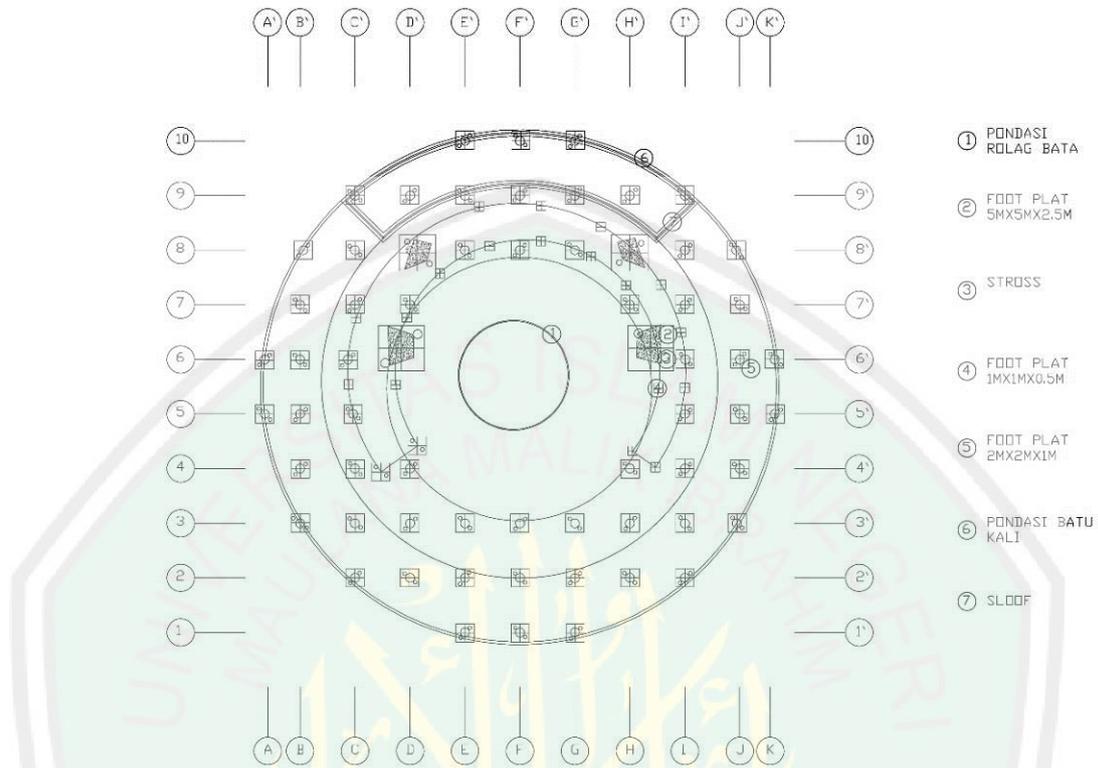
Struktur Pondasi dan Sloof *Exhibition Center
